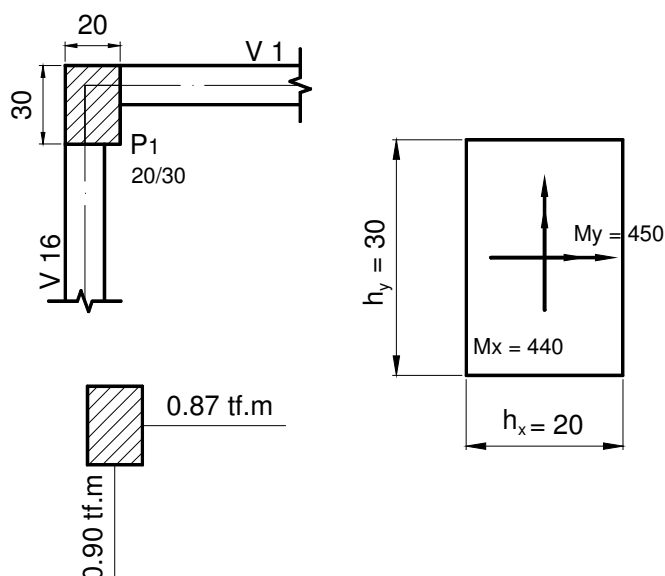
Momentos fletores solicitantes no pilar, oriundos das vigas do pavimento tipo.
